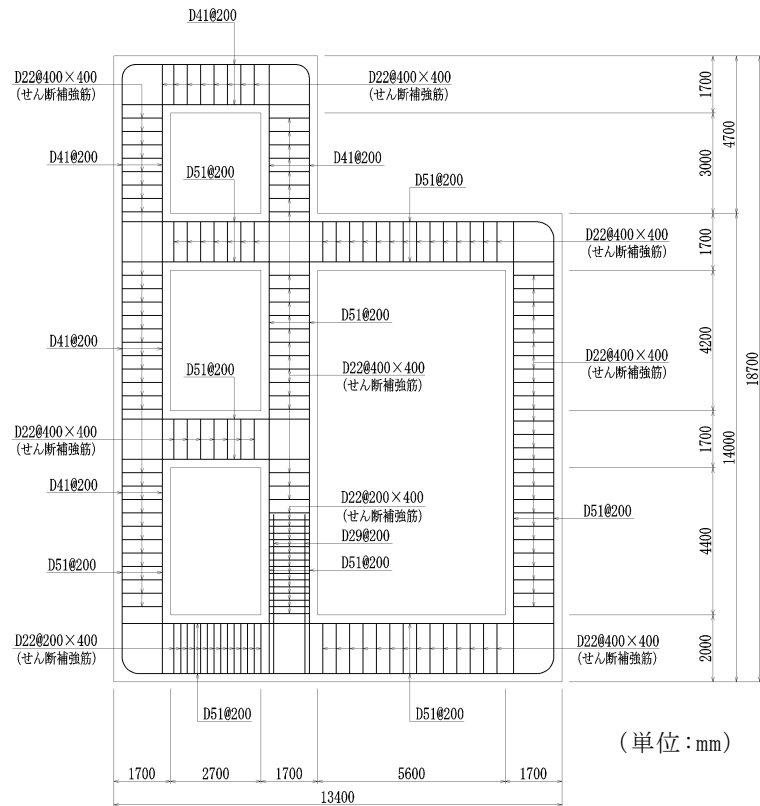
第 1 ベントフィルタ格納槽 概略配筋図 (A-A 断面)
